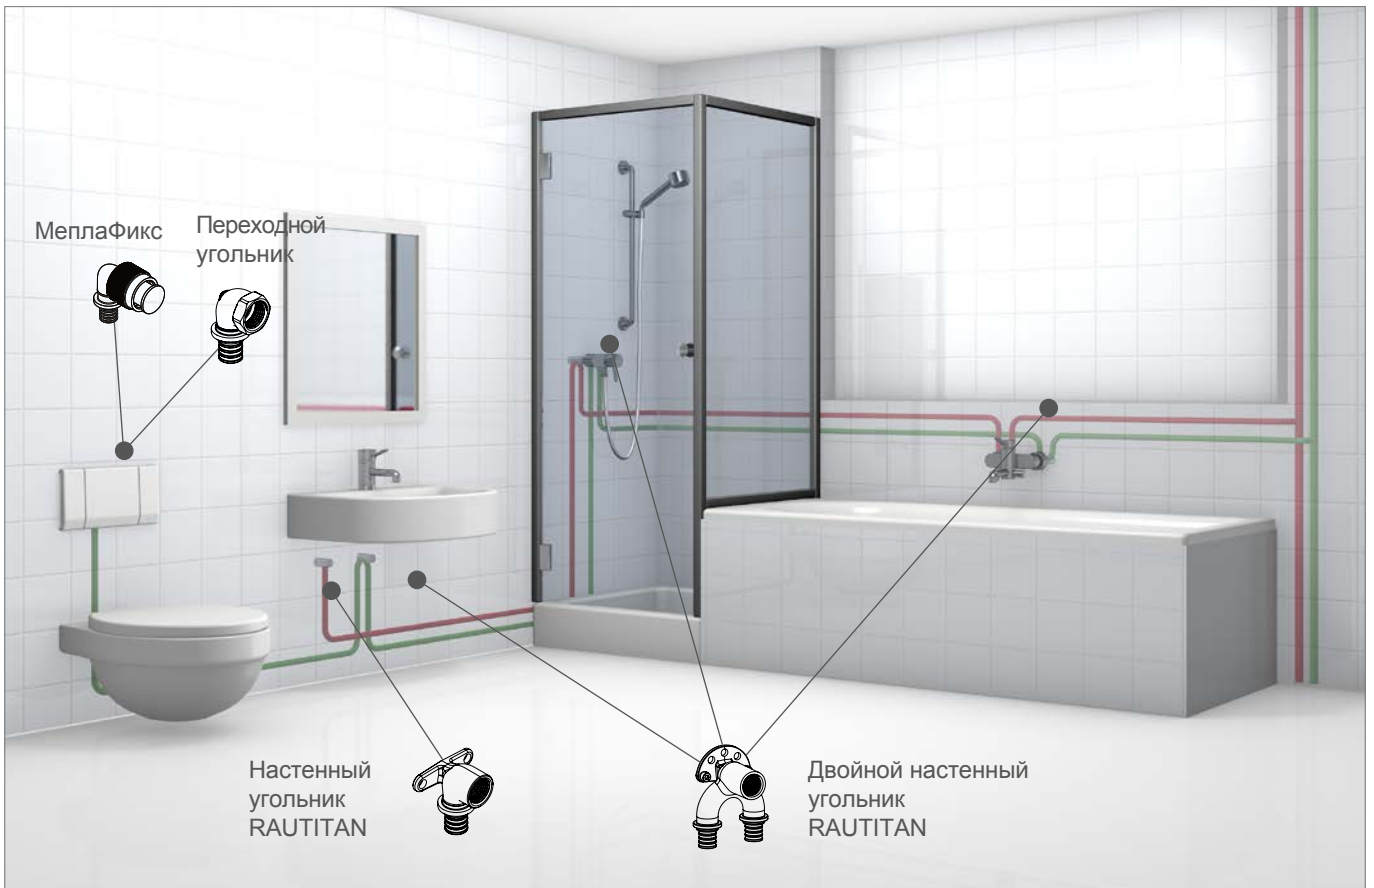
Последовательная прокладка трубопровода с объемом < 3 л - на примере ванной
